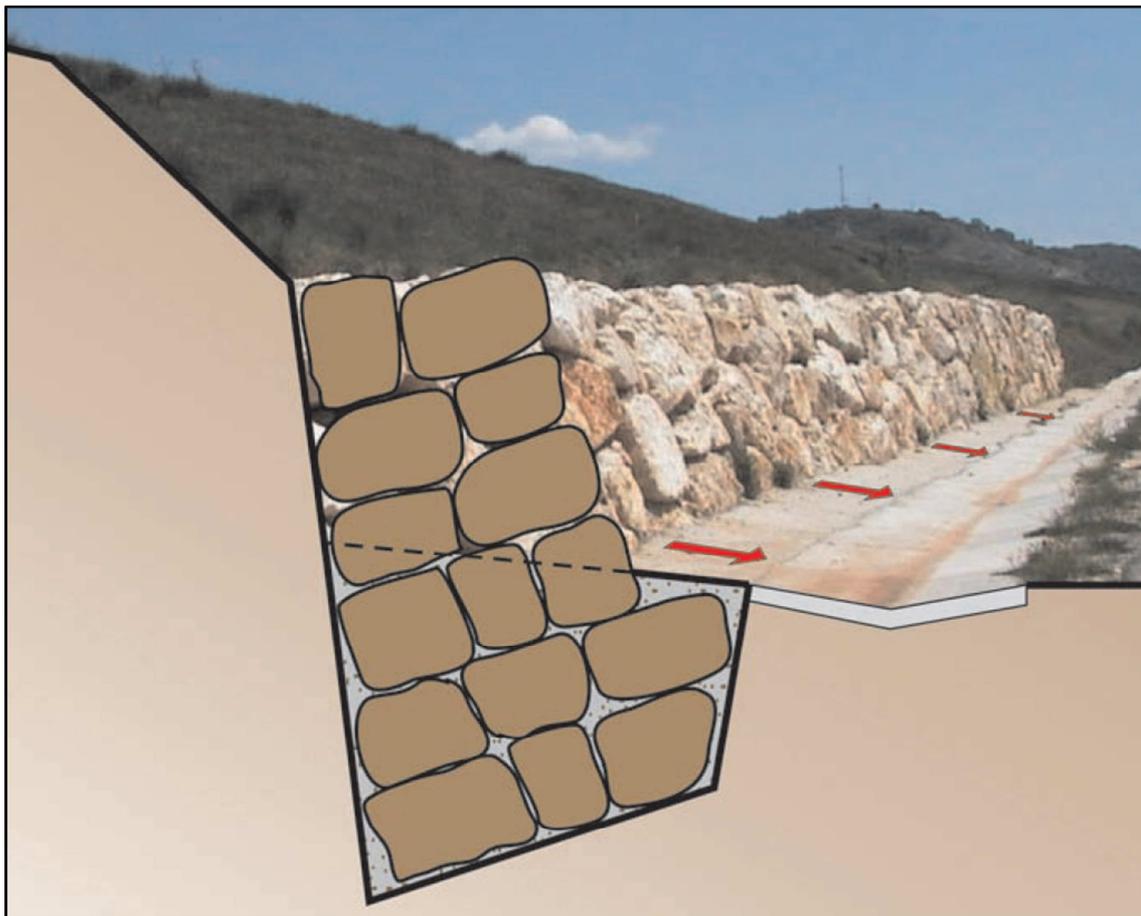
Muro de escollera con pendiente vertiente hacia la cuneta. Fuente: Guía para el Proyecto y la Ejecución de muros de escollera en obras de Carreteras del Ministerio de Fomento.
